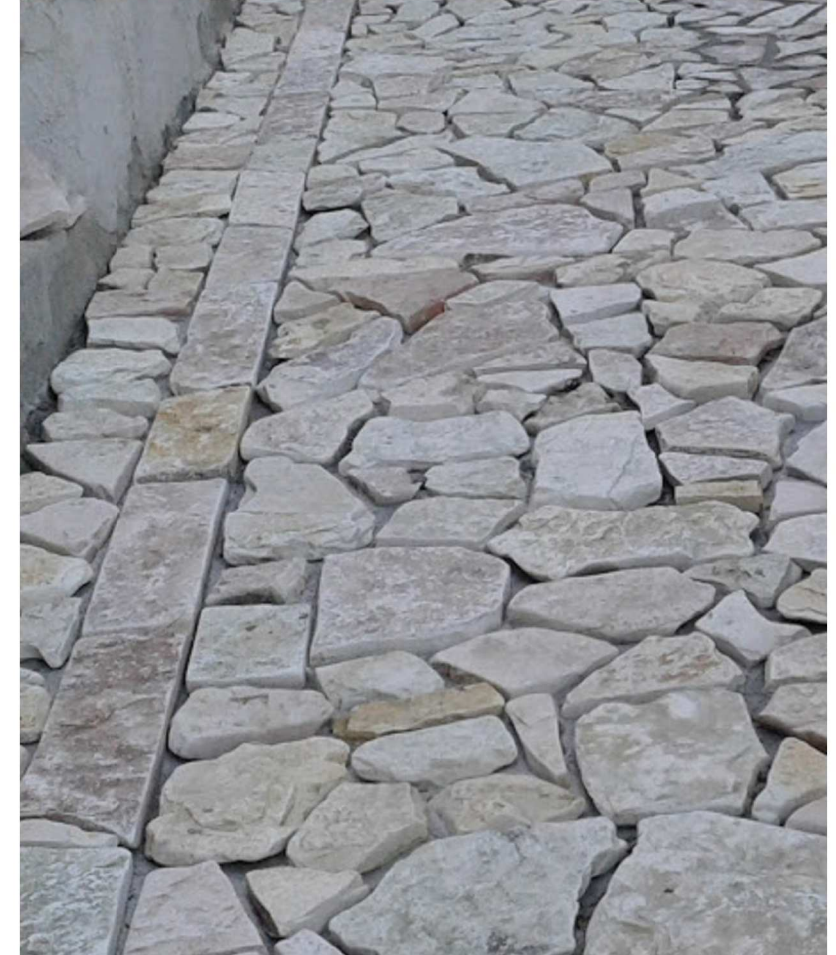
Stato di fatto del Tratto "O-P", con particolare della pavimentazione in pietra
